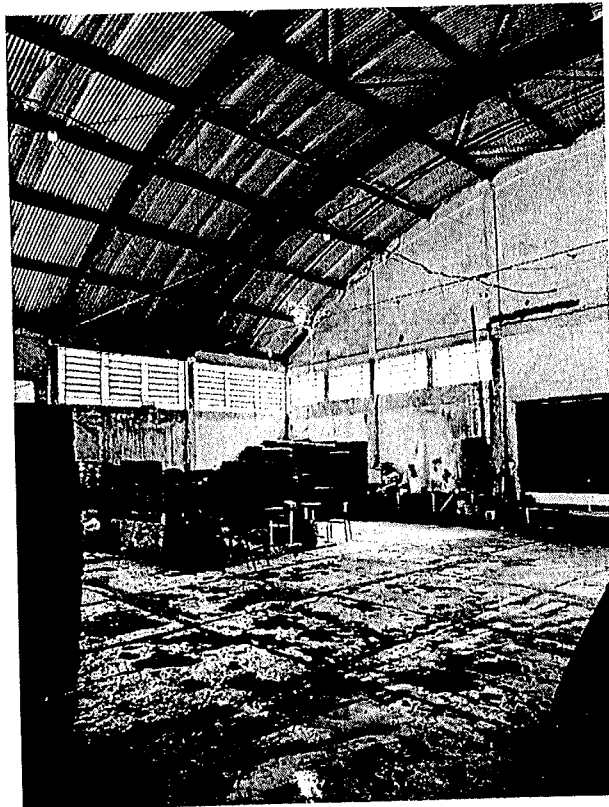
O interior do galpão é definido por um sistema estrutural de cobertura metálica de formato tradicional (duas águas), composta por tesouras (treliças) e terças em perfis metálicos. A sustentação vertical é realizada pelas paredes de alvenaria, que servem de apoio e contêm pilares embutido. A cobertura é realizada com telhas metálicas corrugadas (tipo zinco). O piso é de cimento polido. O ambiente conta com janelas elevadas que utilizam um sistema de venezianas horizontais.
